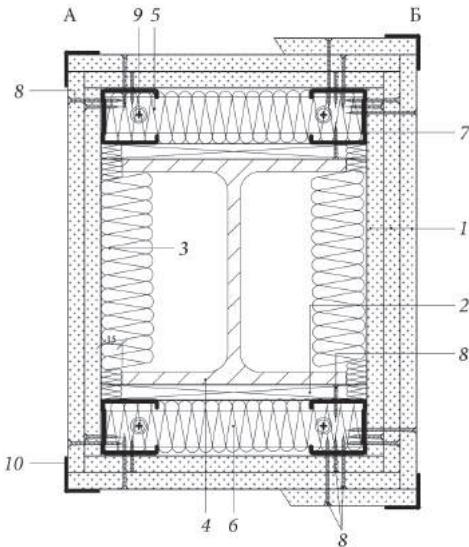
Облицовка колонны с применением ПС- и ПН-профилей: А — двухслойная обшивка; Б — трехслойная обшивка; 1 — ГКЛО; 2 — прокладка из ГКЛО (шаг 1200 мм); 3 — теплоизоляция (минераловатные плиты или маты); 4 — колонна; 5 — ПН-профиль; 6 — дополнительный ПН-профиль; 7 — ПС-профиль; 8 — шуруп; 9 — быстрофиксирующий гвоздь; 10 — угловой защитный профиль с последующим шпаклеванием
